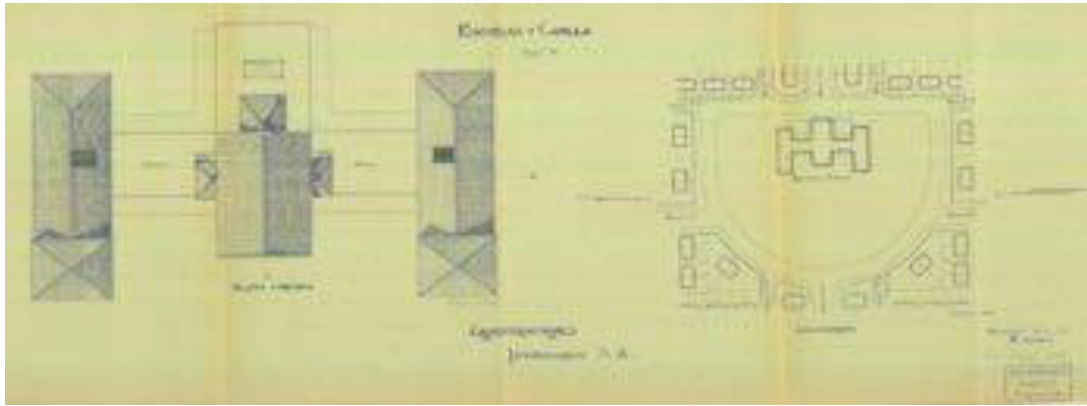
"Escuelas y Capilla. Zona 2ª. Planta Cubiertas y Emplazamiento". José Majó i Ribas. Julio 1928. ACMF CB 171/1.
